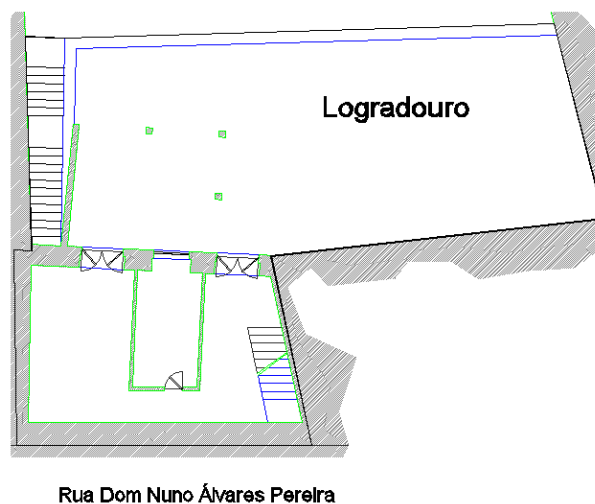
Cave. Lavandaria Americana (Covilhã)
